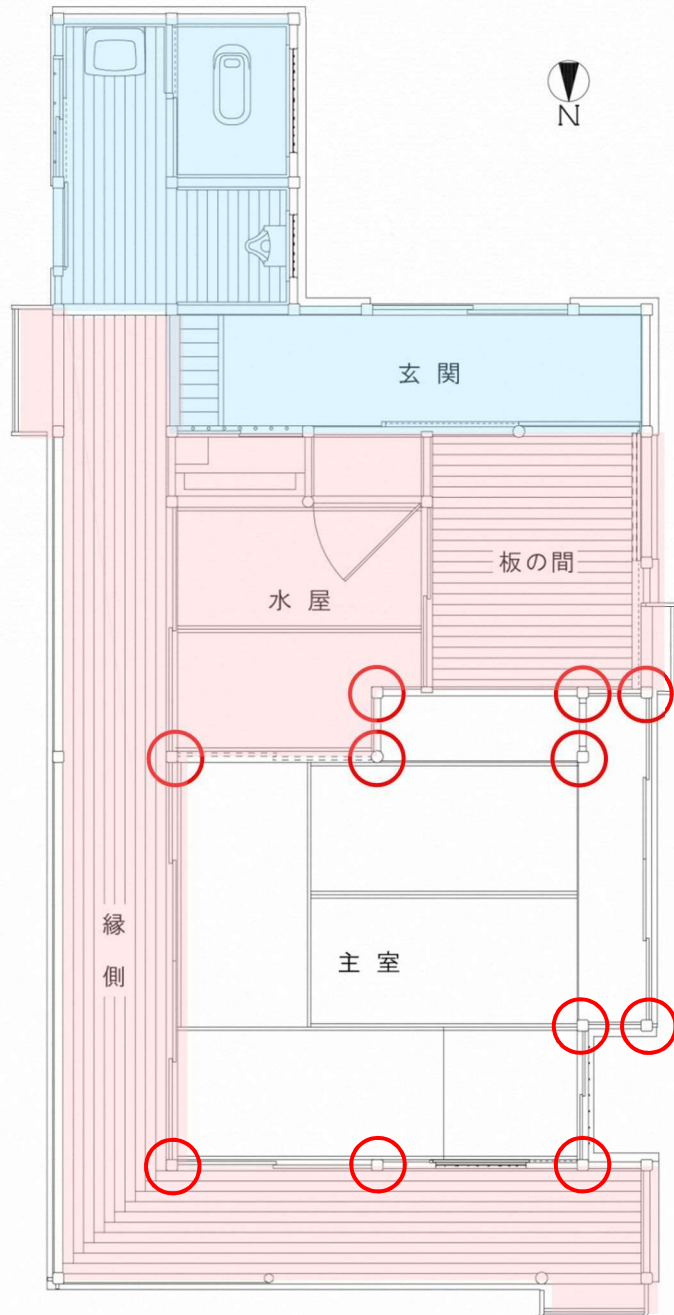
昭和14年移築時の平面図（名古屋市文化財の指定時の平面）
